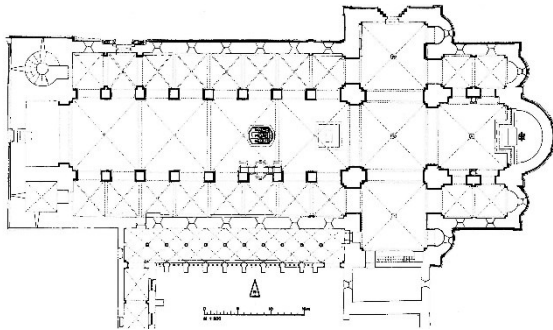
Grundriss der Stiftskirche Königsutter
